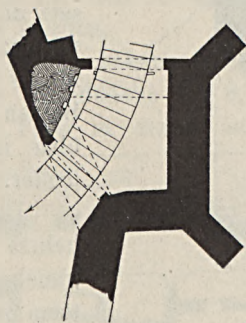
Innentor, Grundriß des Erdgeschosses.
